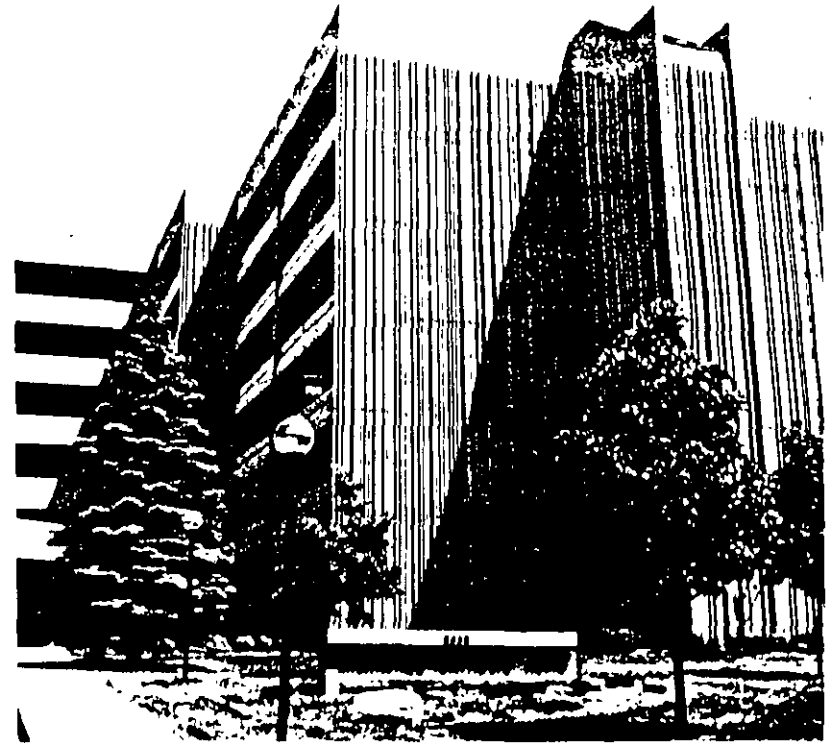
Patrón vertical con juntas de construcción visibles que acentúan el diseño del edificio.
